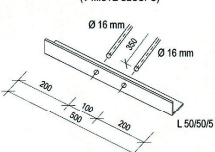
DETAIL ŽELEZOBETONOVÉHO VĚNCE
